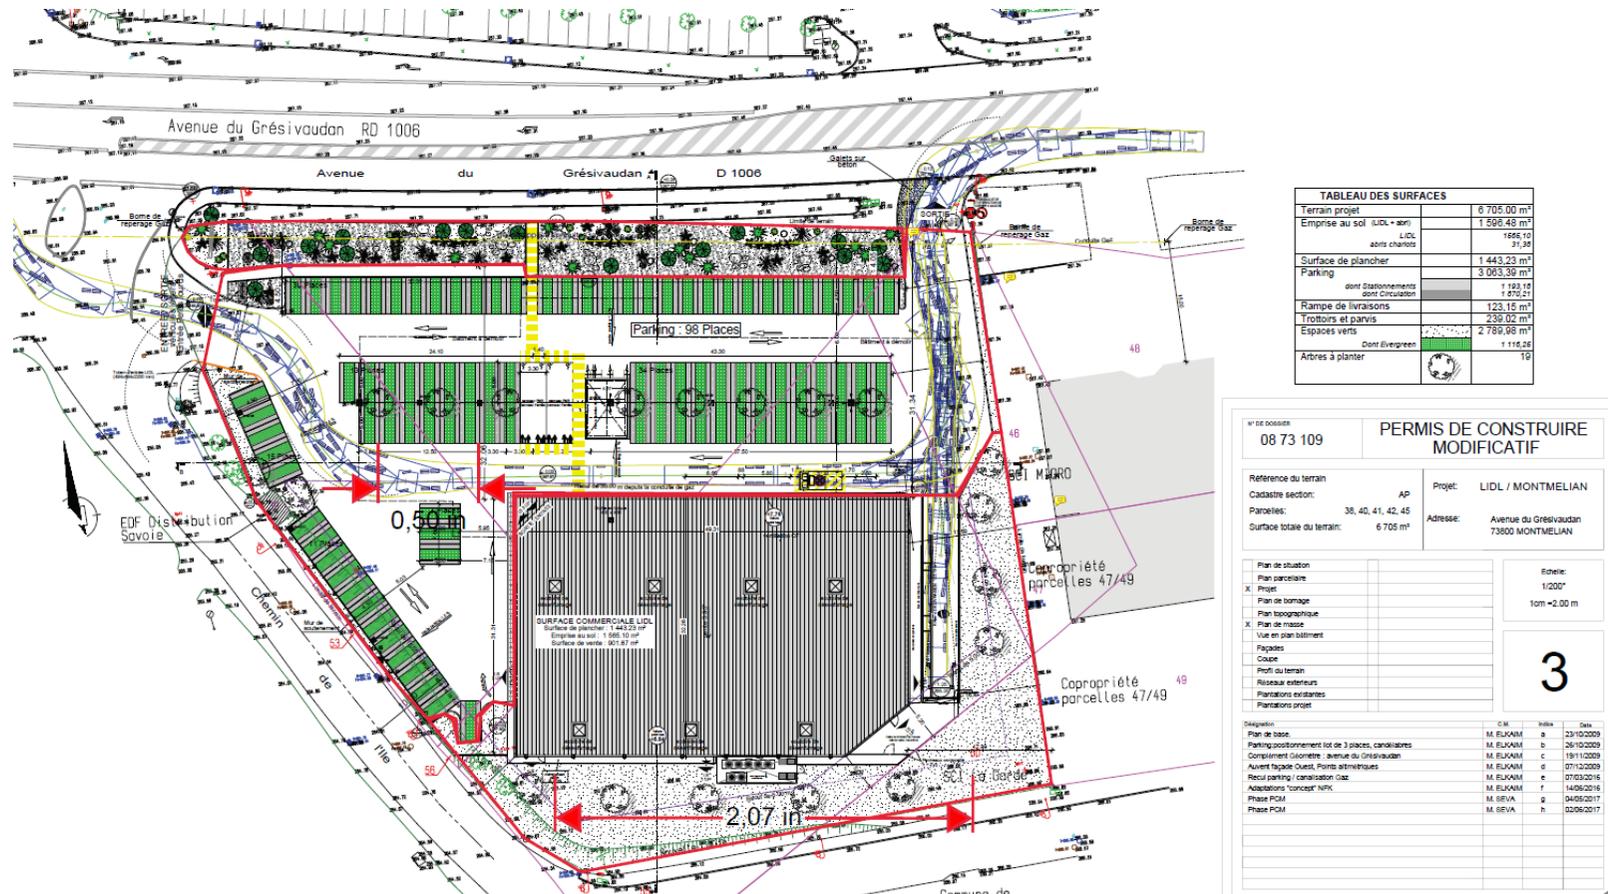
Plan masse du projet (Source : Cabinet d'Architecte Jean-Christophe LARDEAU)
